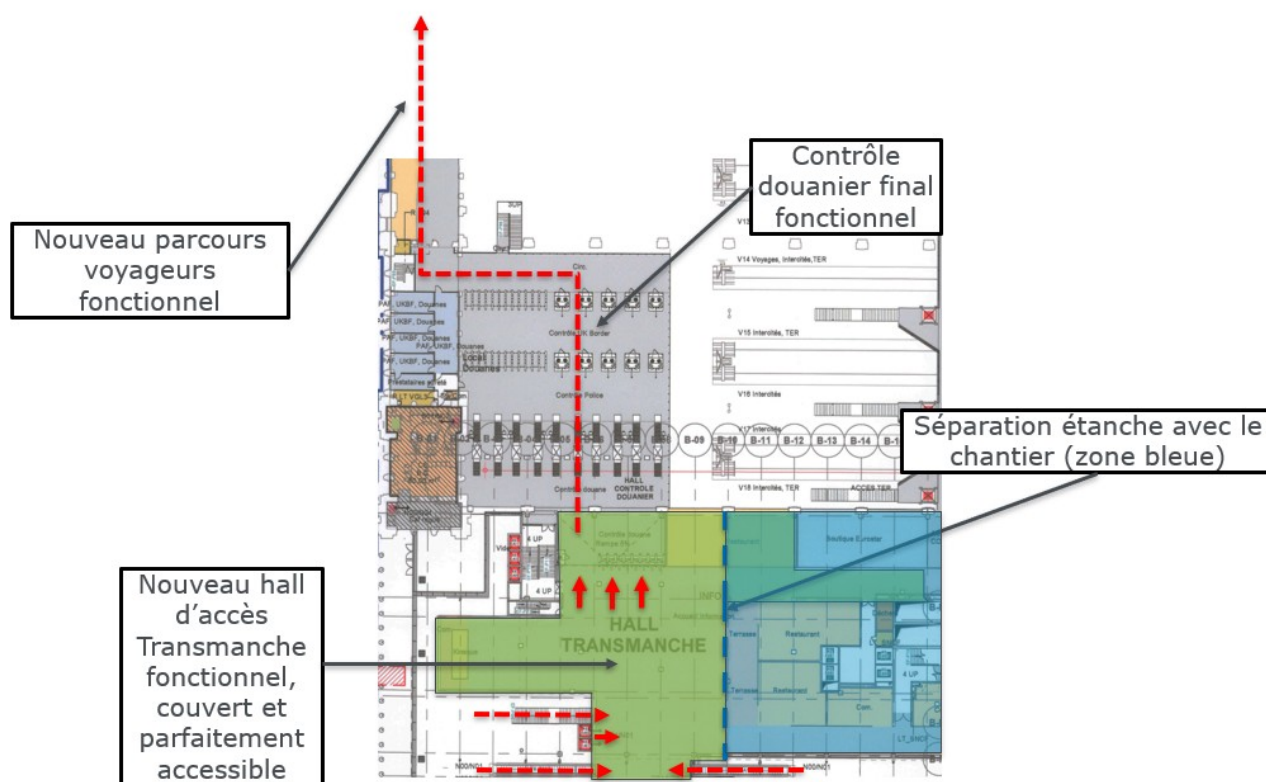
Plan des dispositions provisoires pour l'accueil du public au niveau du terminal Transmanche lors de la coupe du monde de rugby de 2023
